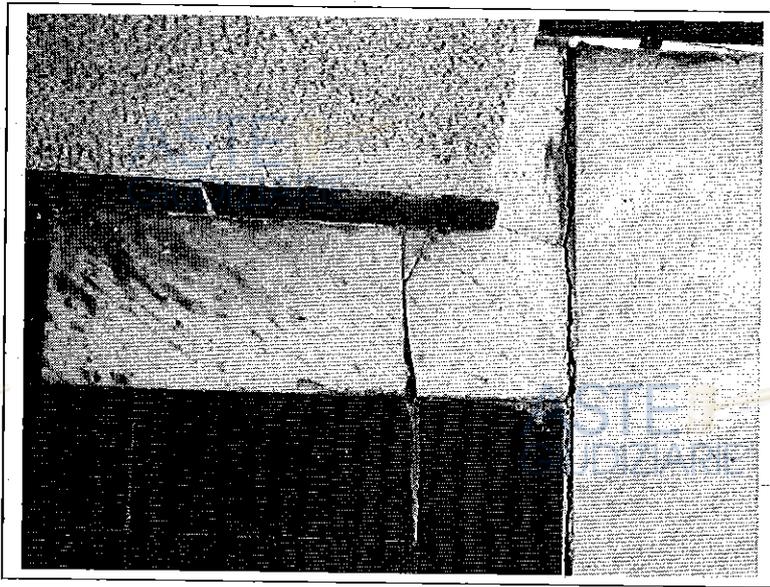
Immobile pignorato. Balcone prospiciente viale Michelangelo.
